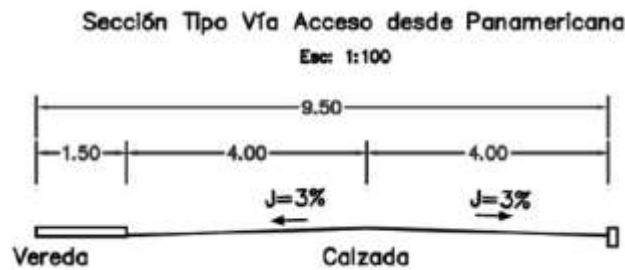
Sección tipo de la vía de acceso diseñada; Fuente: Equipo Consultor Arquitectónico
